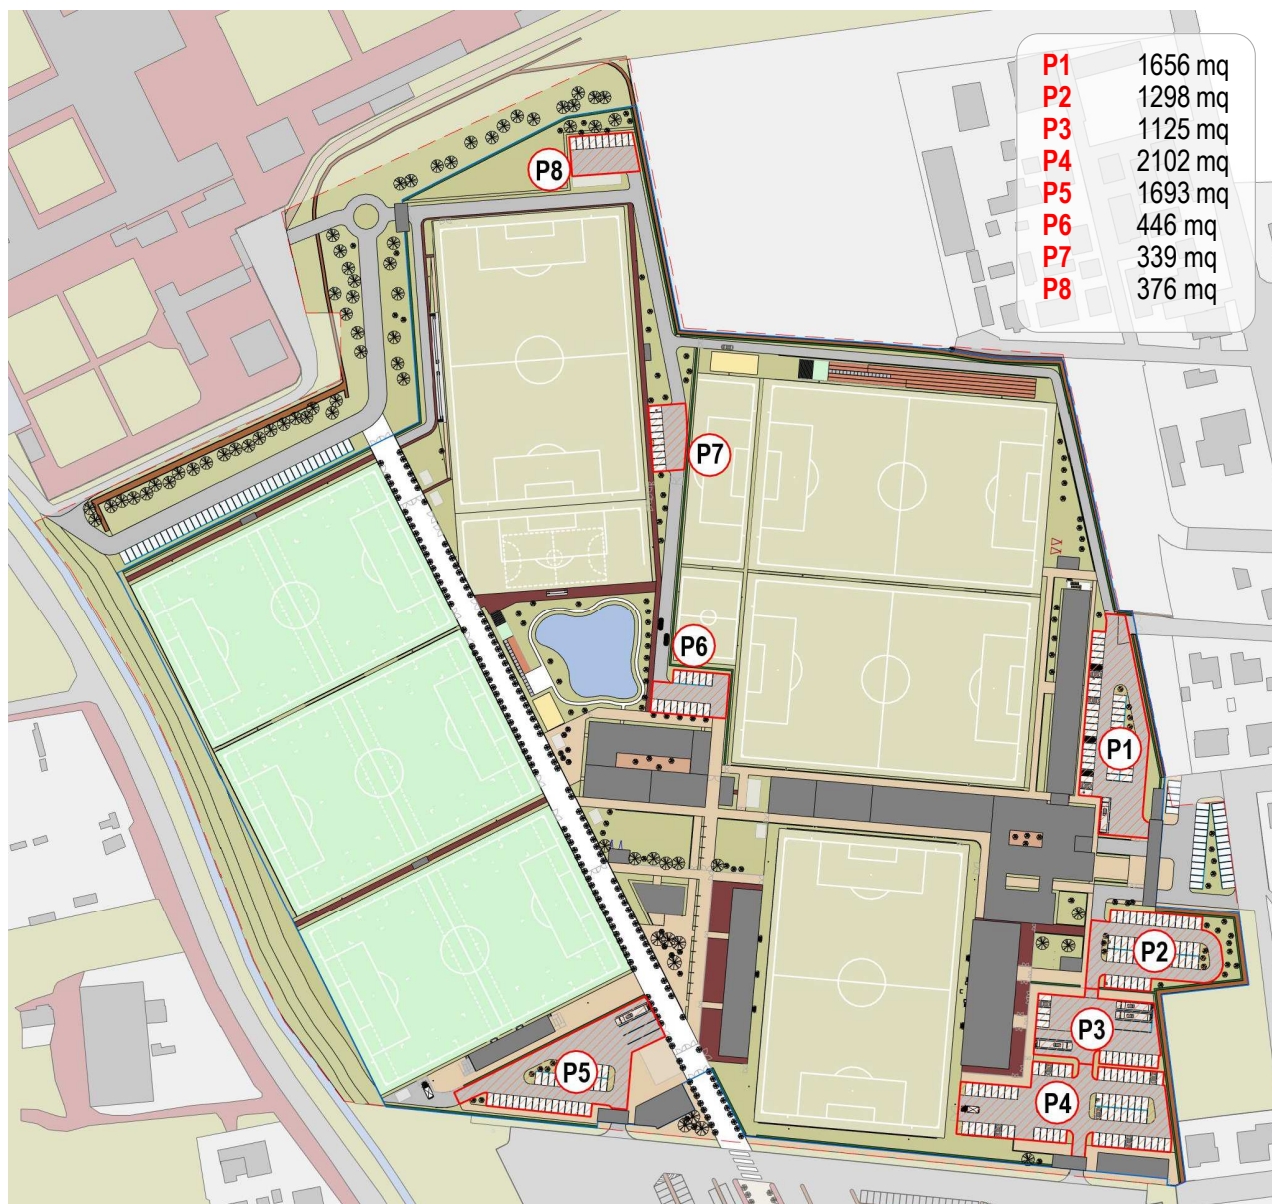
Planimetria di progetto con inquadramento dei parcheggi
